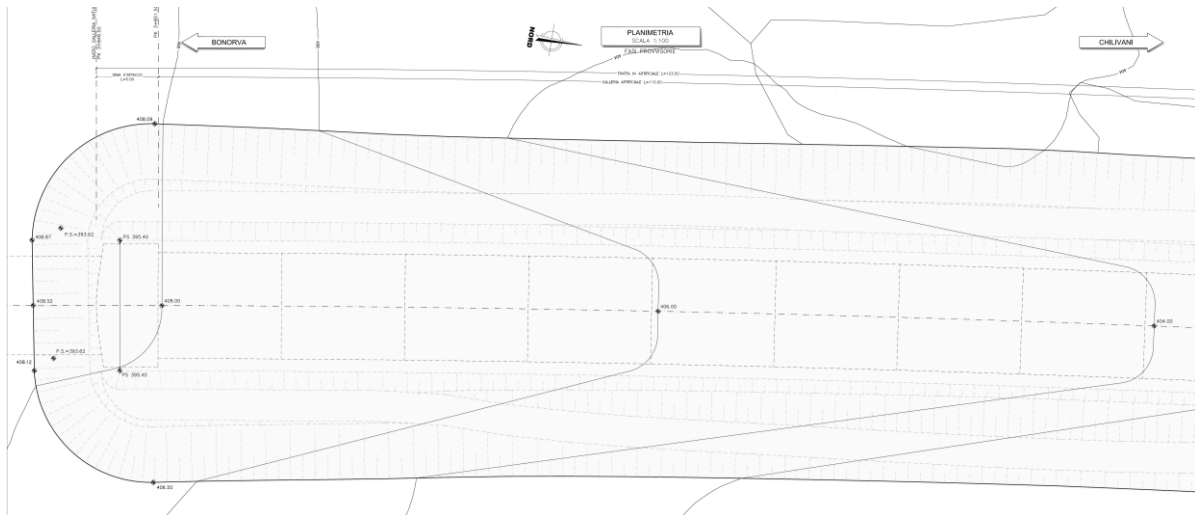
Galleria Bauladu – Imbocco lato Bonorva – Planimetria in fase definitiva
